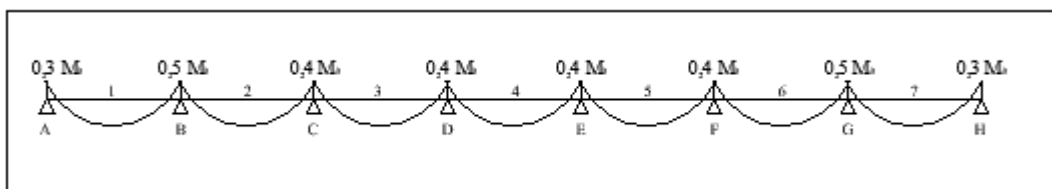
Schéma statique de la poutrelle sur 8 appuis.
